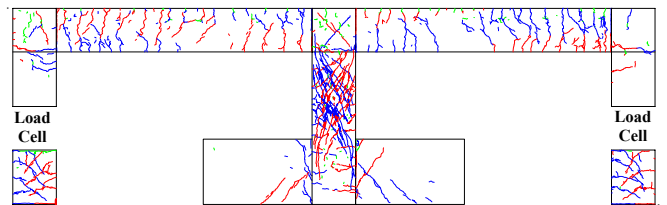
層間変形角 1/100rad.負側除荷時のひび割れ状況
